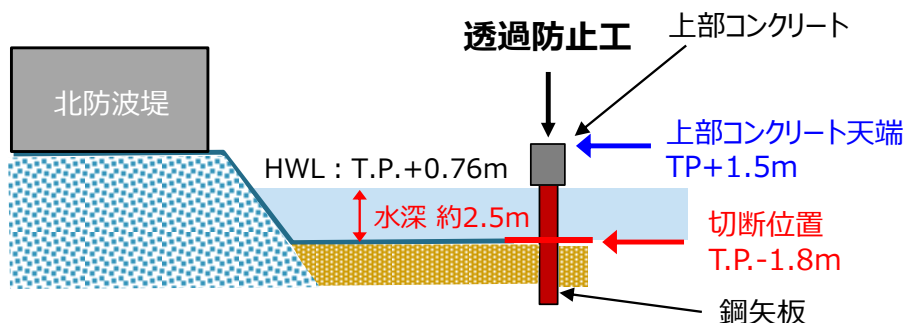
透過防止工改造断面図 (A-A 断面)
